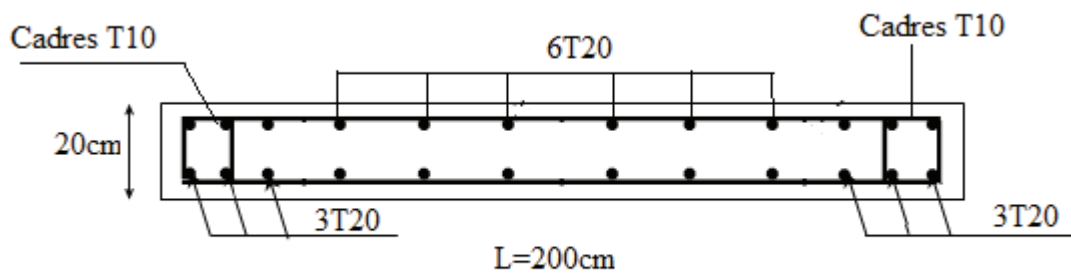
Schéma de ferrailage du voile V_{x2} au niveau du RDC
